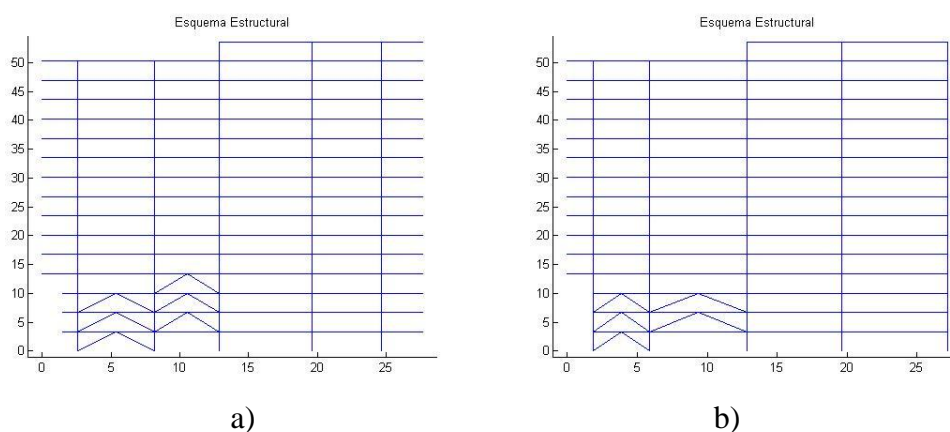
Pórticos transversales reforzados a) Pórtico 1; b) Pórtico 3.
